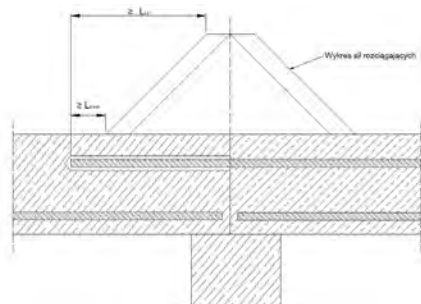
Mocowanie końcówki płyt betonowych i dźwigarów zaprojektowanych jako swobodnie podparte
